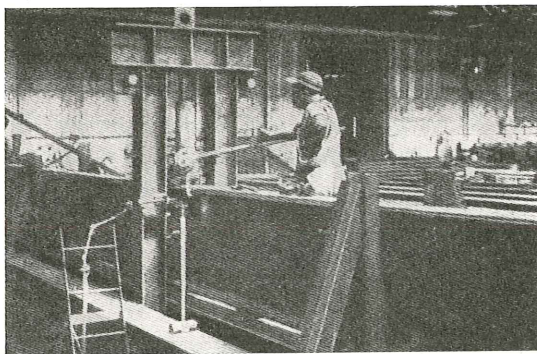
Detalle de la predeformación de vigas, de 82 y 76 cm de canto, con tensiones iniciales de 2.100 Kg/cm² en el acero ordinario y 3.800 Kg/cm² en la chapa de acero especial, bajo las sobrecargas. En estas vigas se obtuvo un ahorro del 25 por 100.
